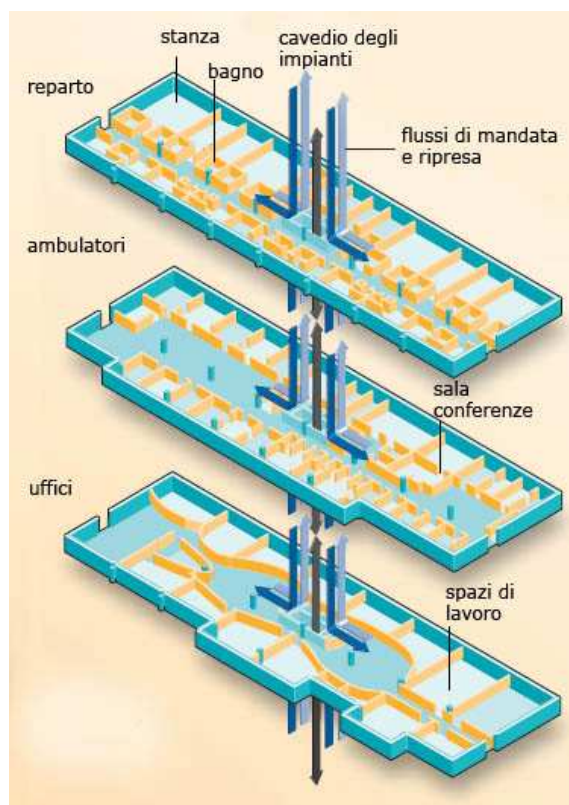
schema impiantistico. (Fonte: Burger Grunstra Architekten).
